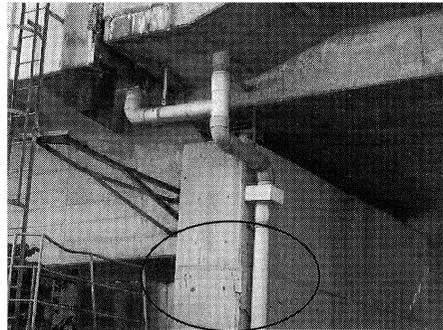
P3 橋脚橋座部のせん断ひび割れ
